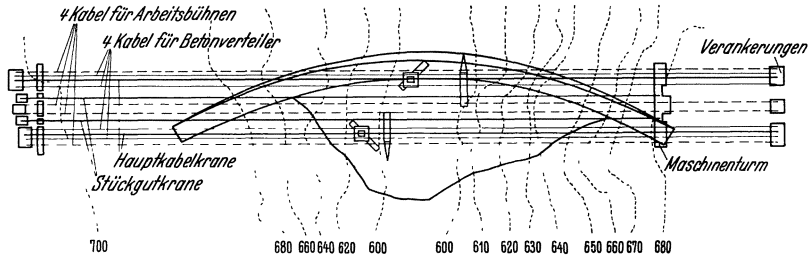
Draufsicht auf die Betonierausrüstung der Esla-Staumauer (Spanien).
